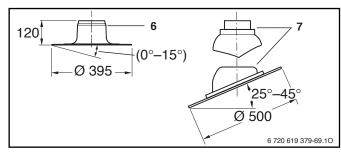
Tegola universale e flangia adesiva tetto piano (quote in mm)
